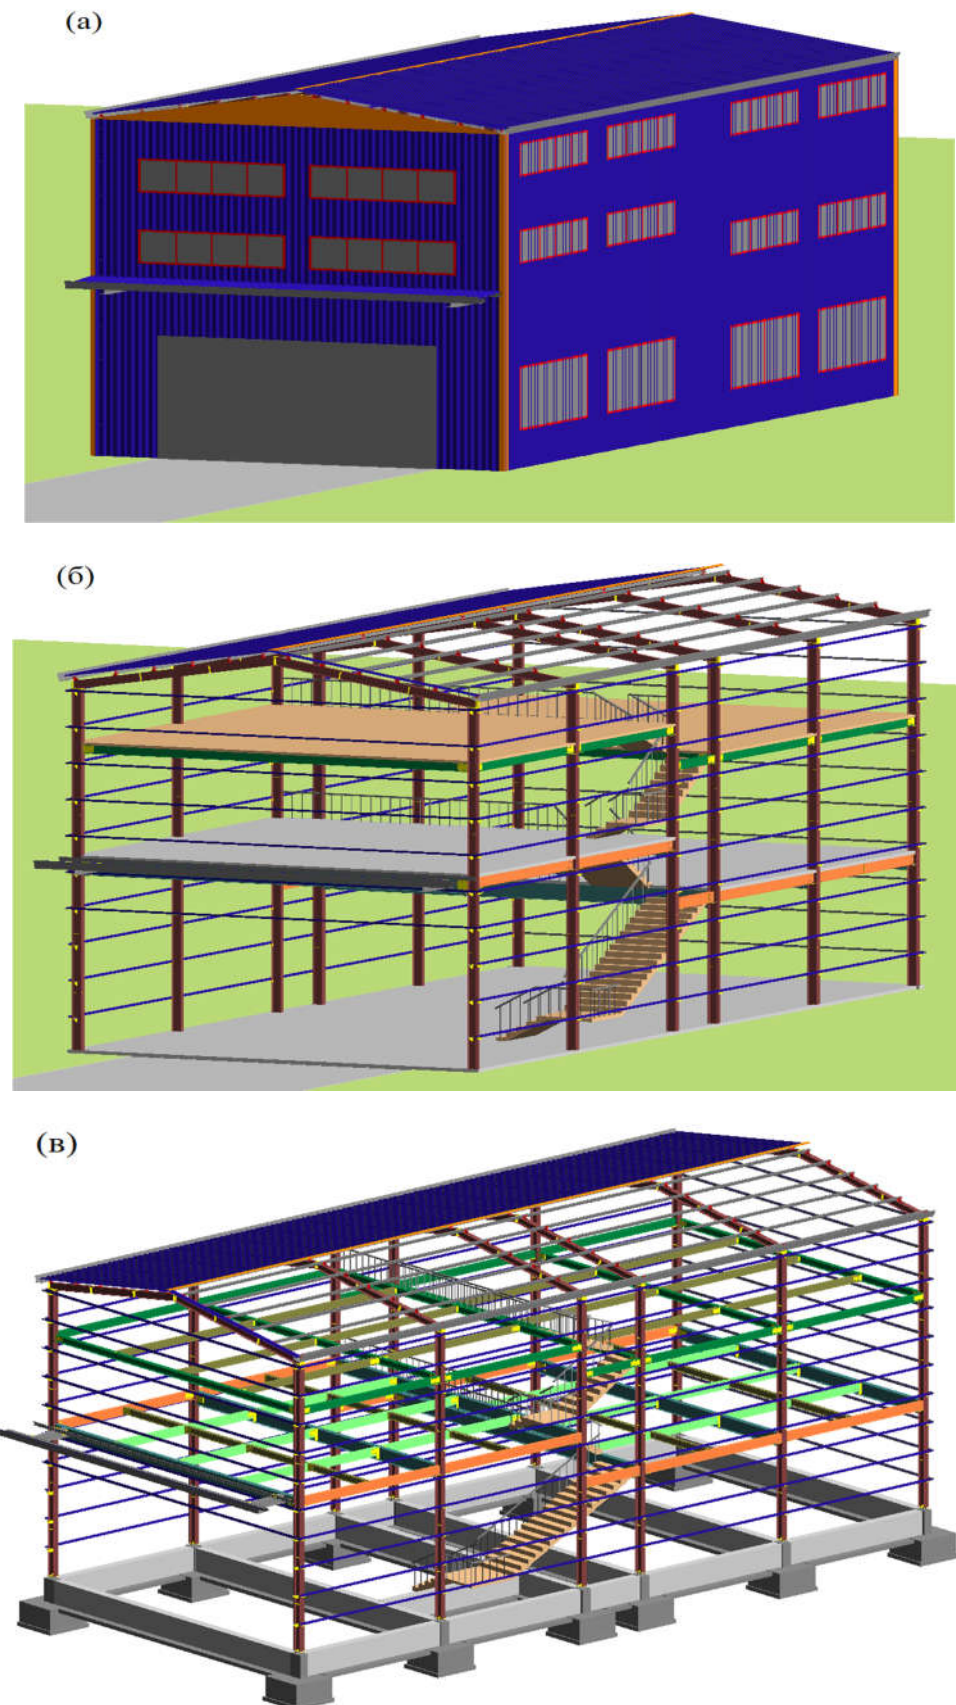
Жилое здание: (а) внешний вид здания; (б) стержневая система несущих конструкций; (в) металлическая конструкция с железобетонным фундаментом
